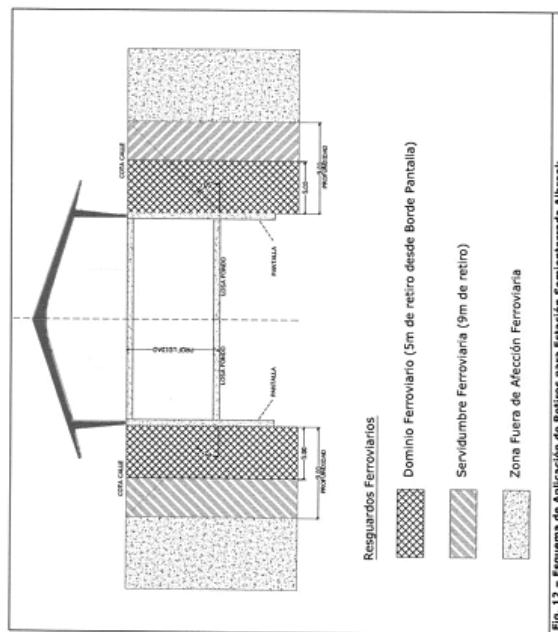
Esquema de Aplicación de Retiros para Estación Semienterrada Albrook
